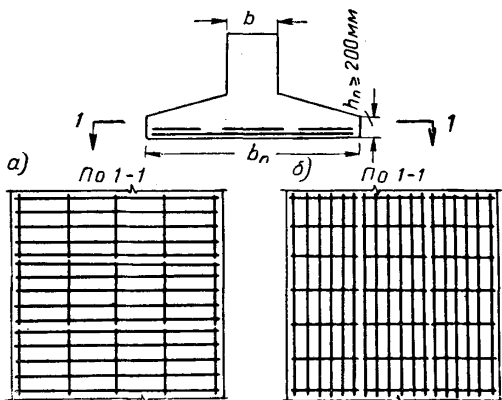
Армирование плиты ленточного железобетонного фундамента узкими сварными сетками
